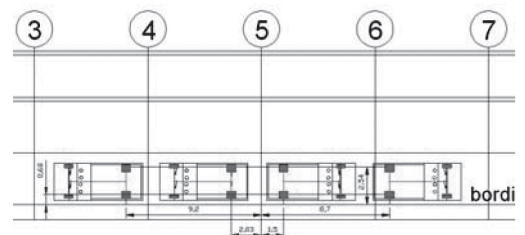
Localización en planta de las volquetas, en la tercera hipótesis, localización en el tablero del puente.
